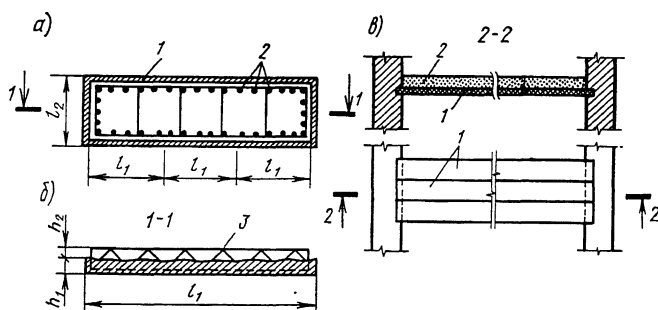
Опалубка из железобетонных и армоцементных плит
